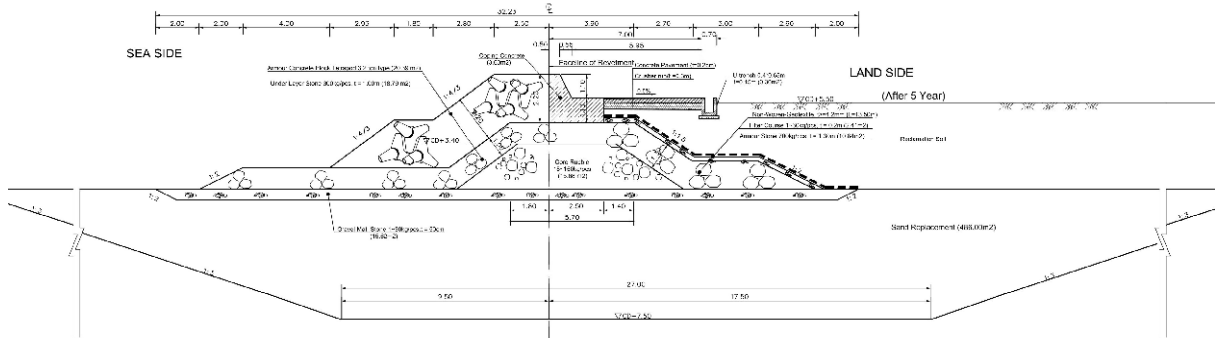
Mặt cắt ngang điển hình của Đê chắn sóng B
